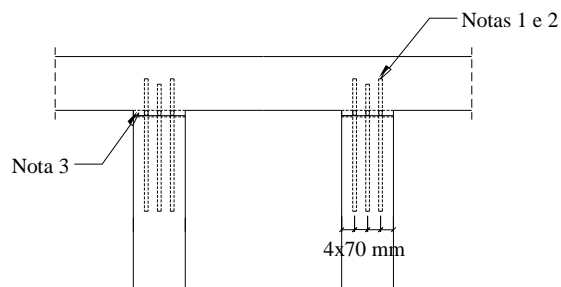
Secção transversal do sistema de ligação (secção AA).
